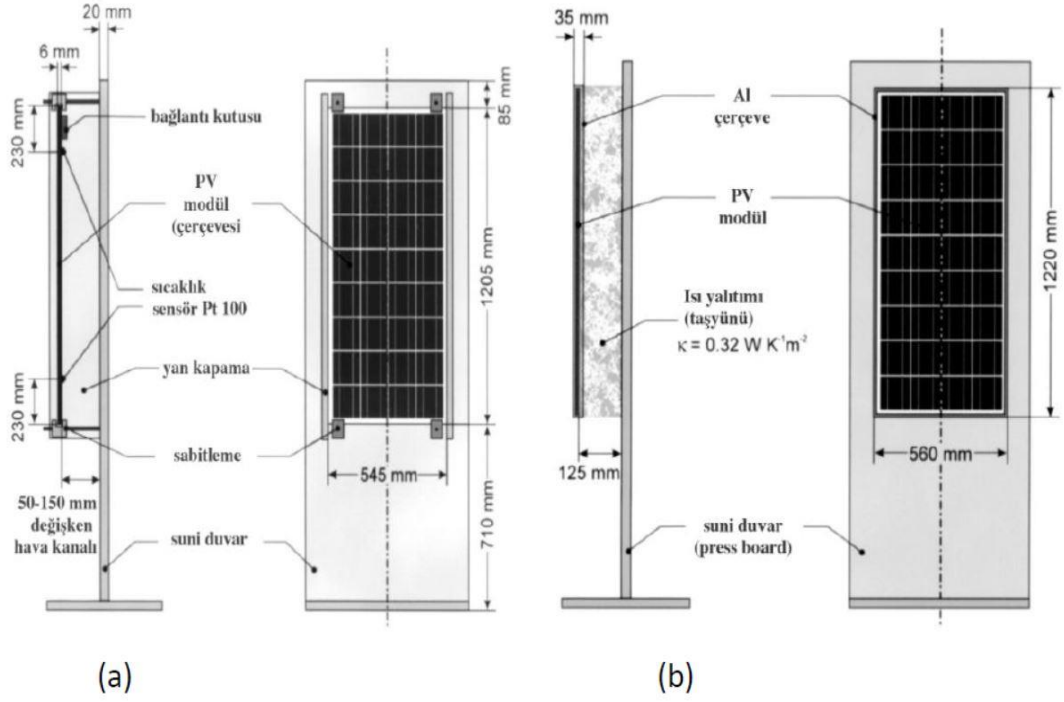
Yapılarda kullanılan PV kolektör detayı [6]
